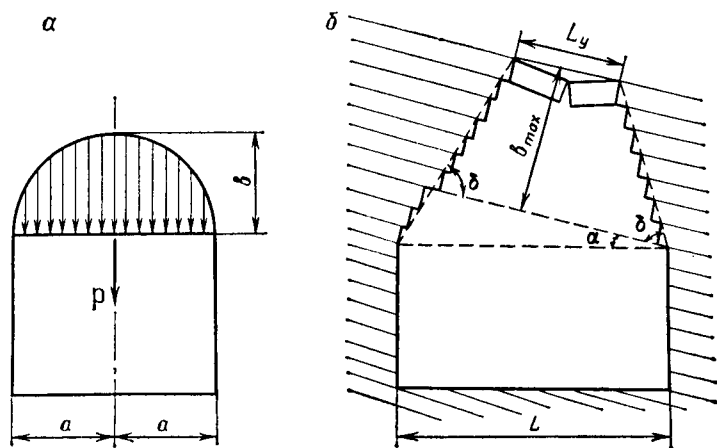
Схема к расчету нагрузки на крепь горизонтальных выработок со стороны кровли методом:
